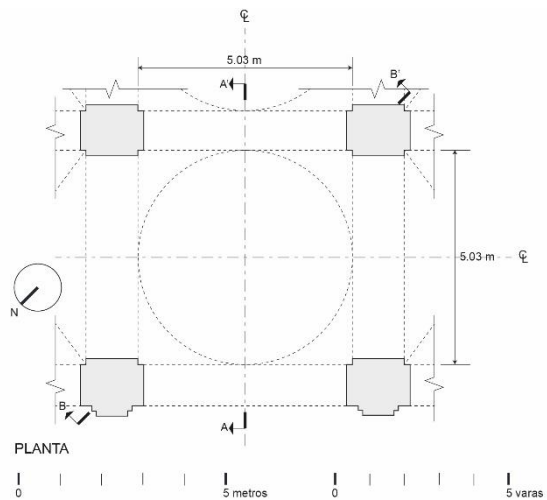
93 Planta arquitectónica de un tramo en la nave central del vestíbulo
